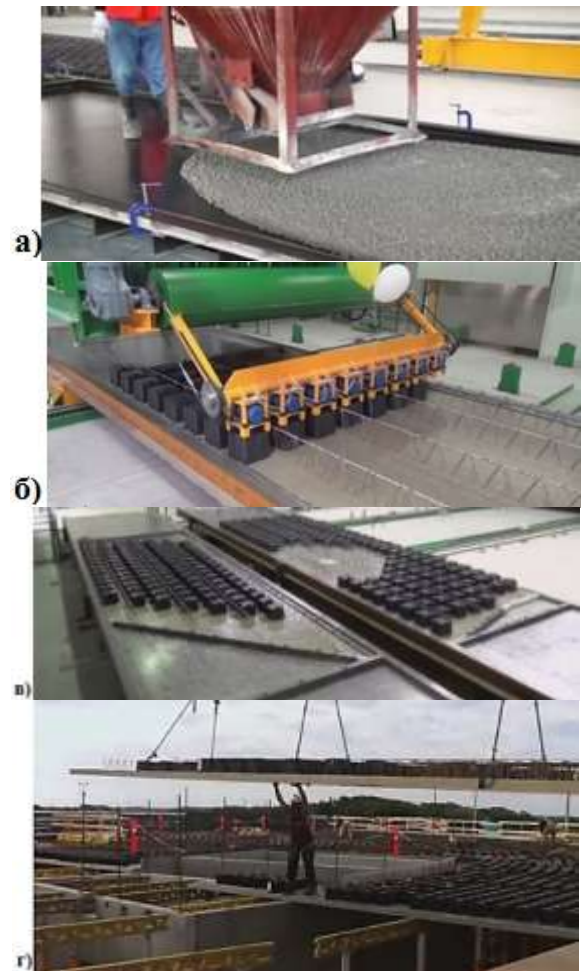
Устрійство облегчених залізо-бетонних перекриттів по технології Airdeck: а) бетонування збірної часті плити; б) автоматическа установка вкладкишей-пустотообразователей; в) плити, готові к транспортуванню; г) установка плит на проектне положення
